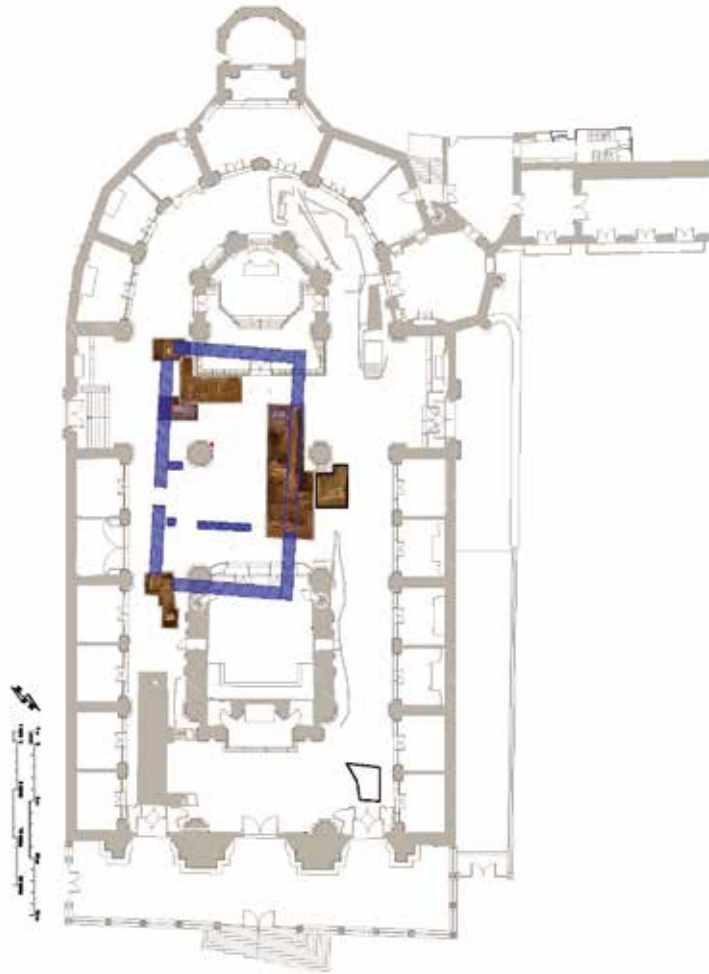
Planta de San Patricio y superposición de la planta hipotética de San Jorge.
